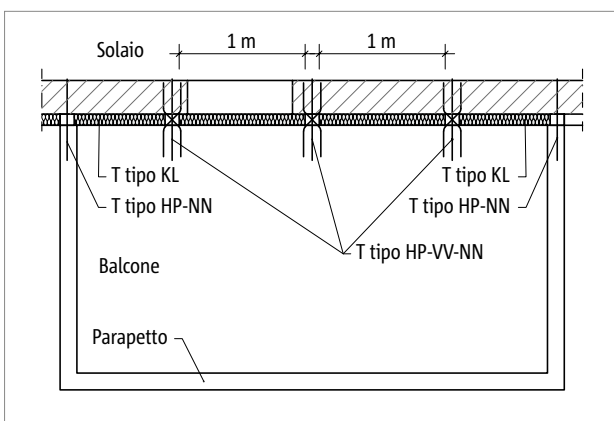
Disposizione di Schöck Isokorb® T tipo KL, tipo HP-VV-NN e tipo HP-NN (variante 1)
